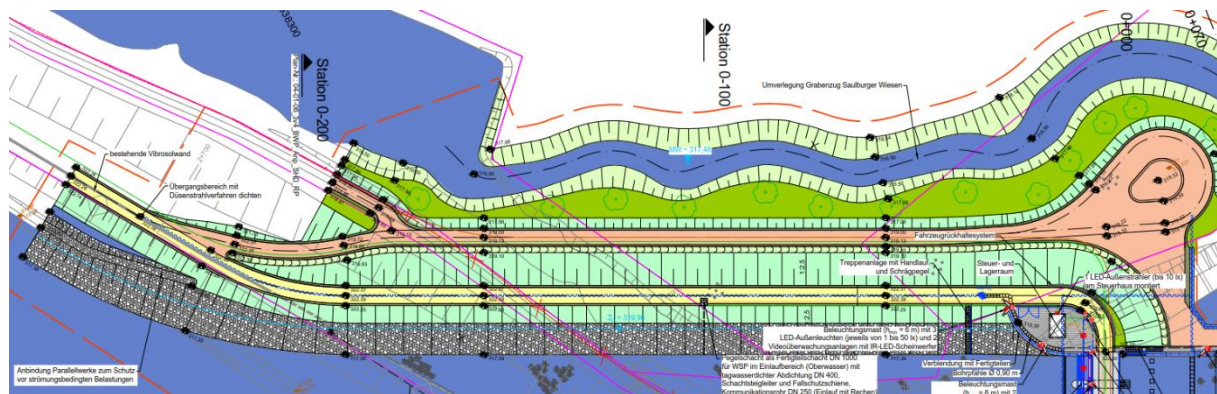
Ersatzneubau Stauhaltungsdamm, Ausschnitt Detaillageplan (aus Plan 04-01-01)
